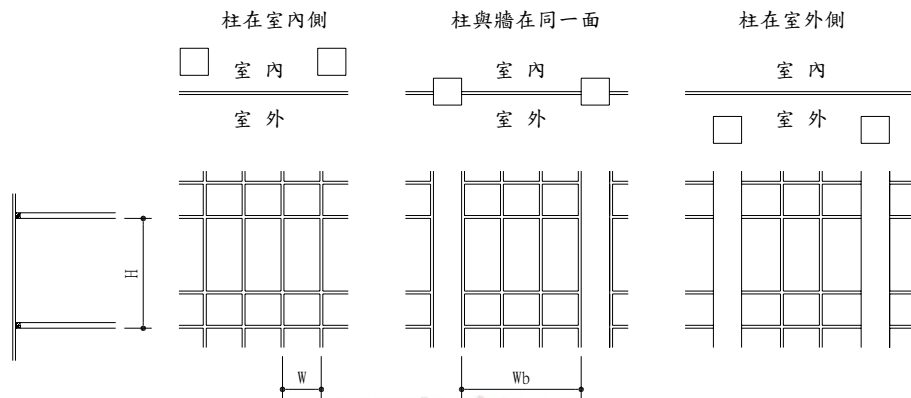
掛簾型式 (Curtain Wall) 帷幕牆
